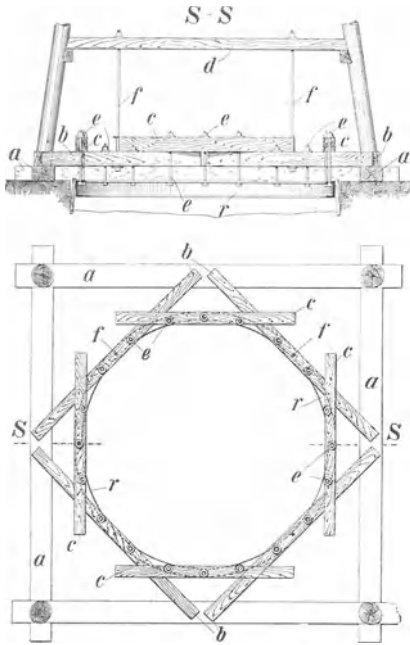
Aufhängung des ersten Ringes unmittelbar unter der Tagesoberfläche.
